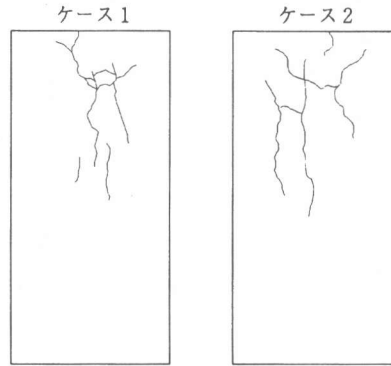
定着部ひび割れ状況 (1.0Pu)
